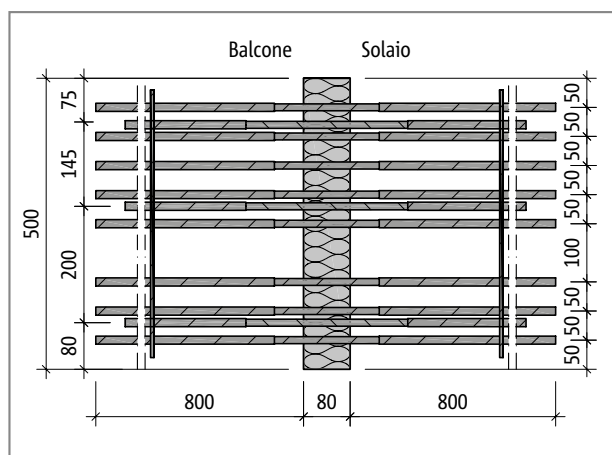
Schöck Isokorb® tipo KP150L-V14: pianta del prodotto
